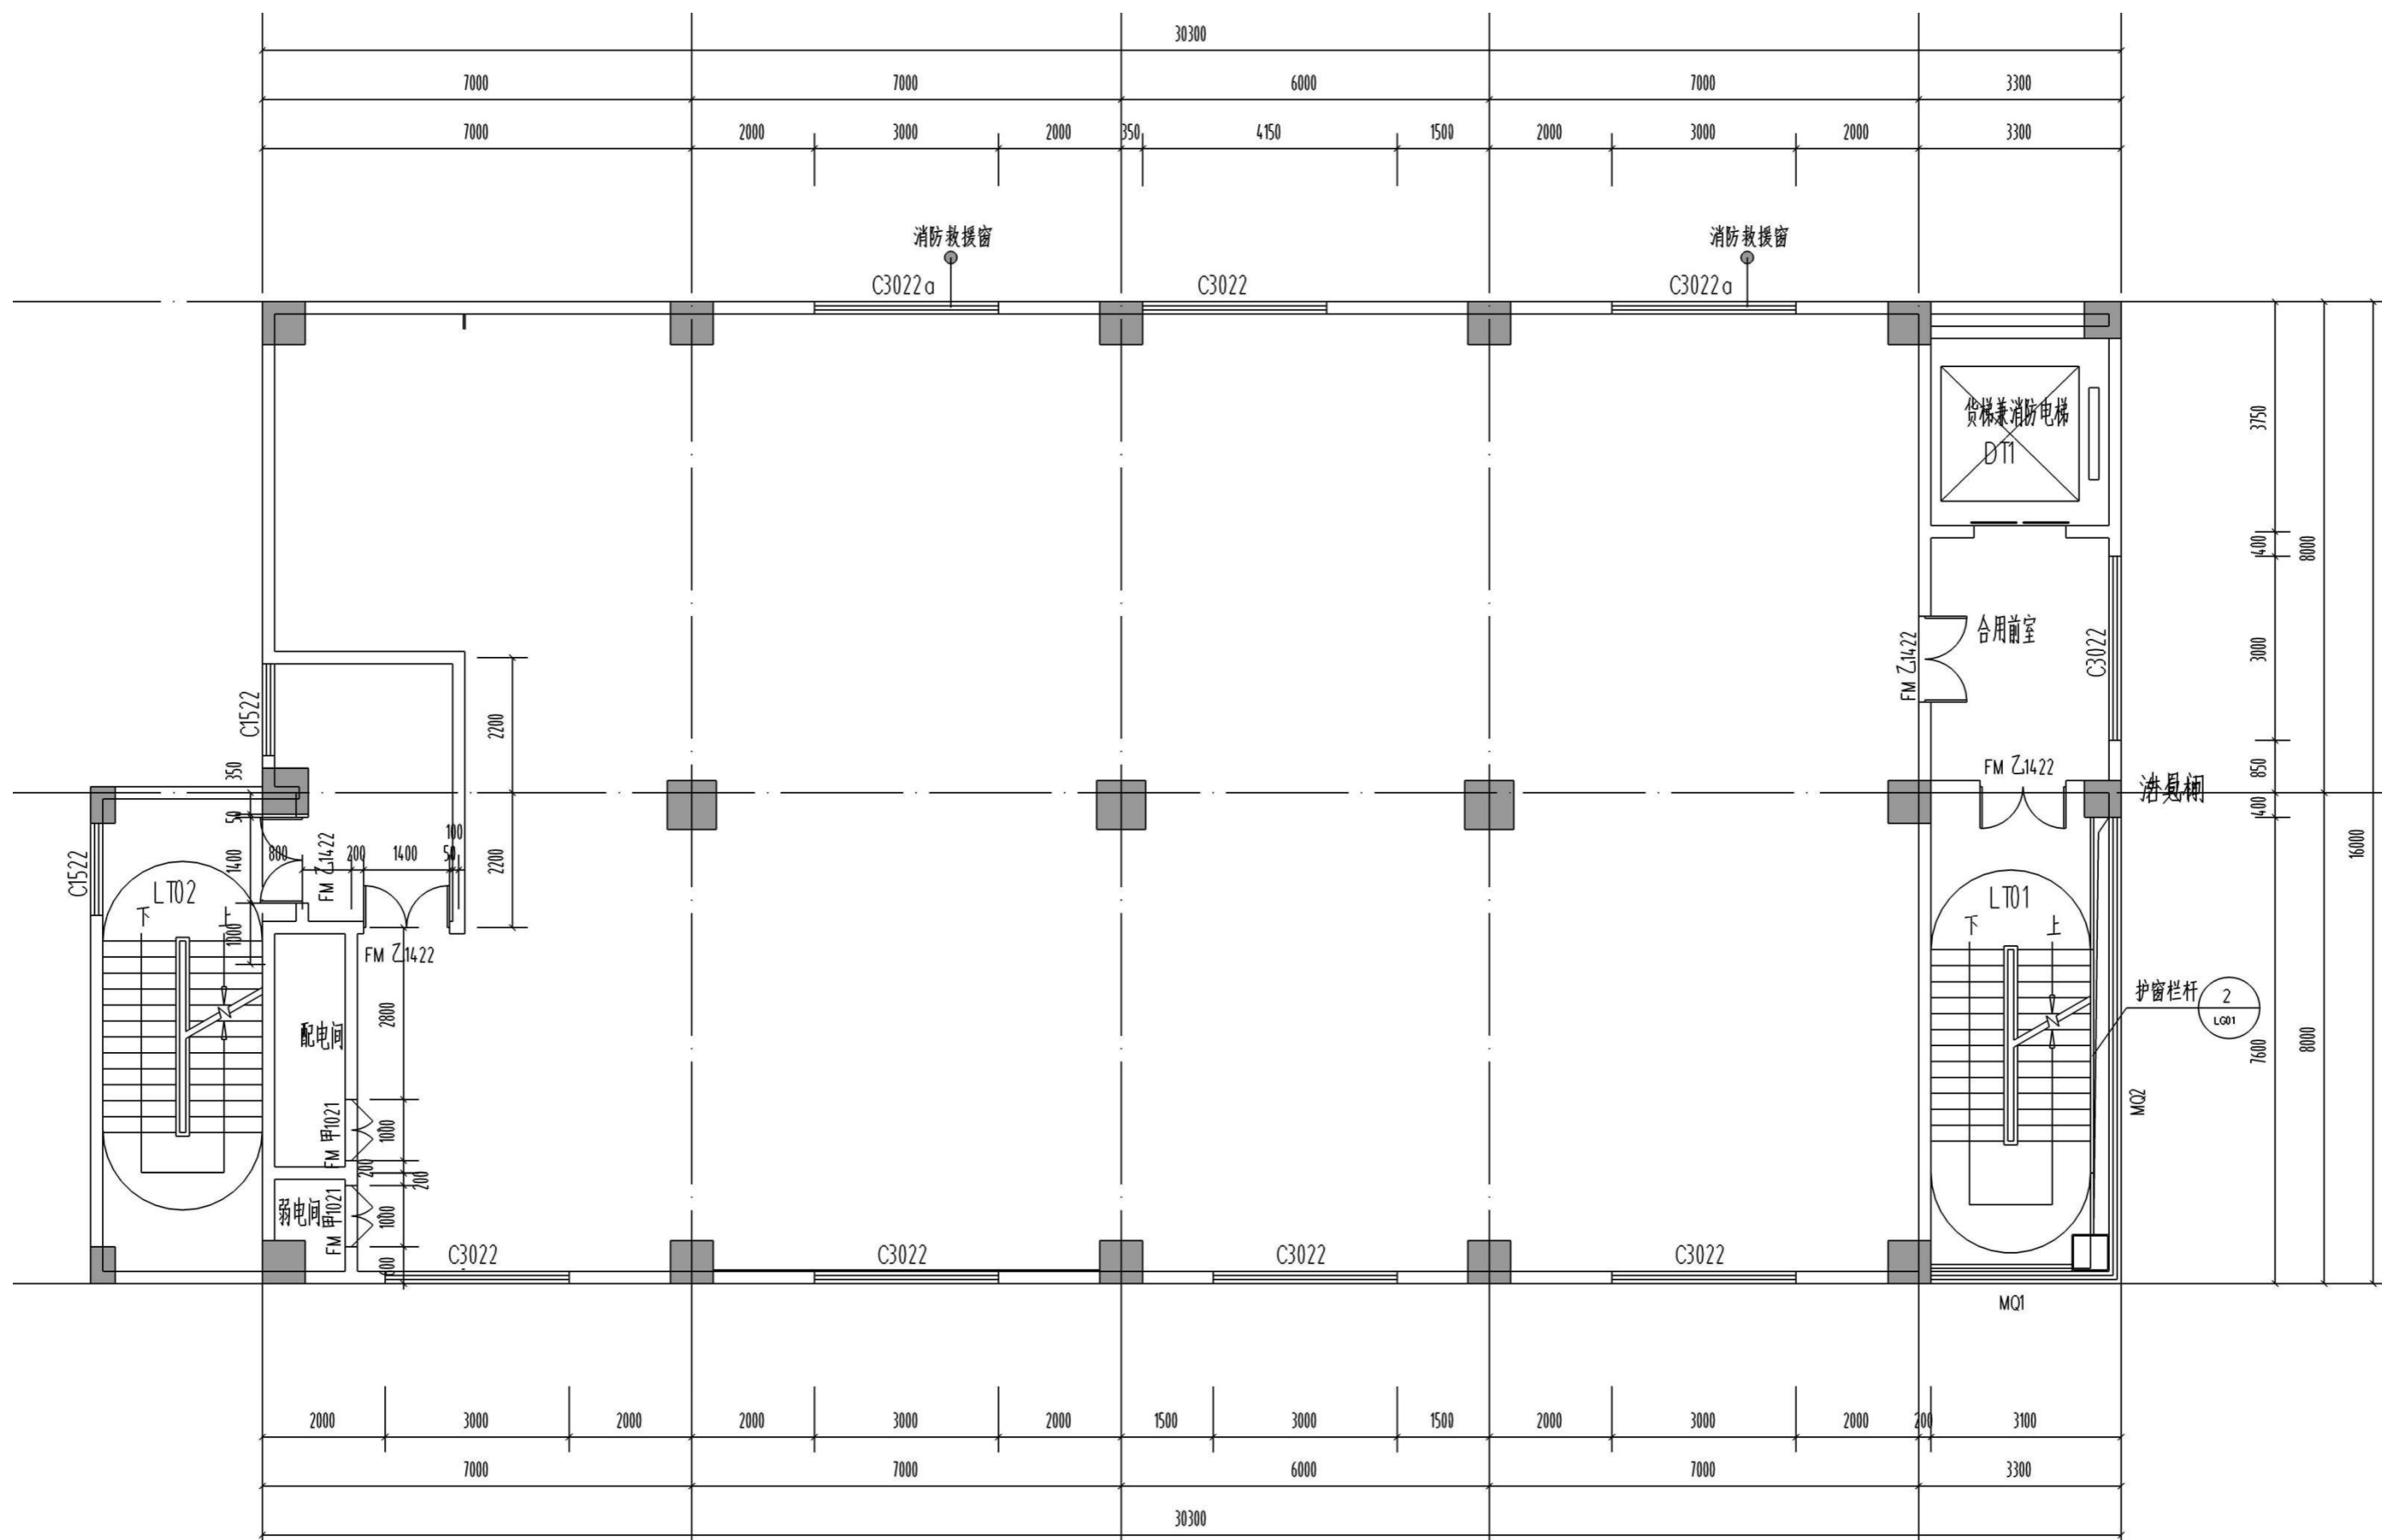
七层（配料间）平面布置图（比例尺 1:100）
